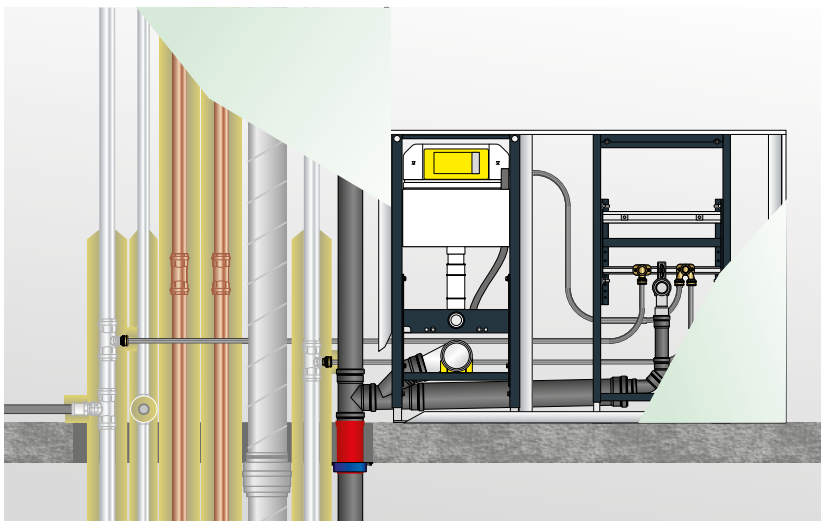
Schachtaufbau mit Kunststoffabwasserleitungen
